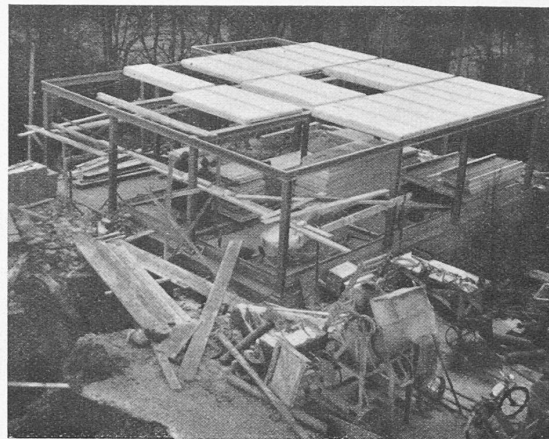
Grösseres Haus mit Stahlskelett im Bau
